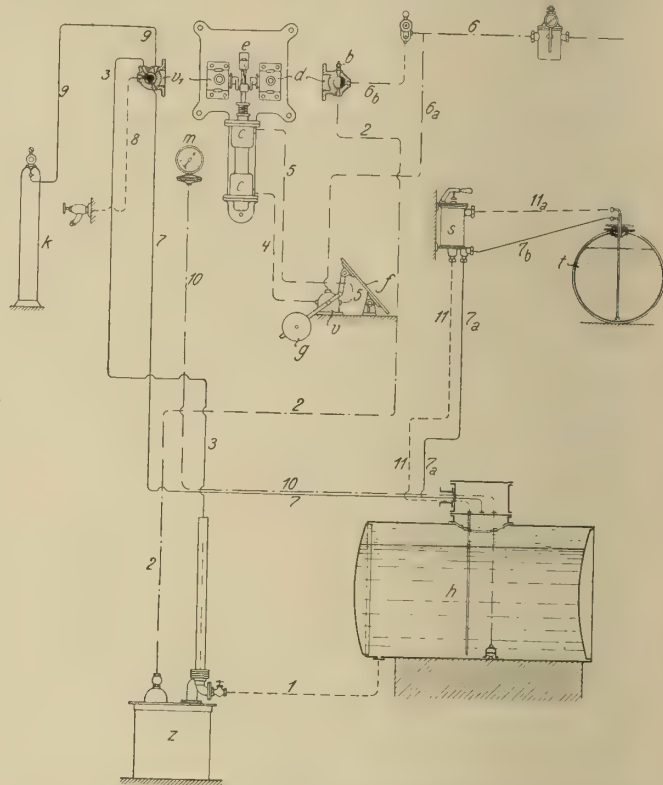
Einrichtung zur Benzin-Aufbewahrung und -Umfüllung von Grümer und Grimberg.
